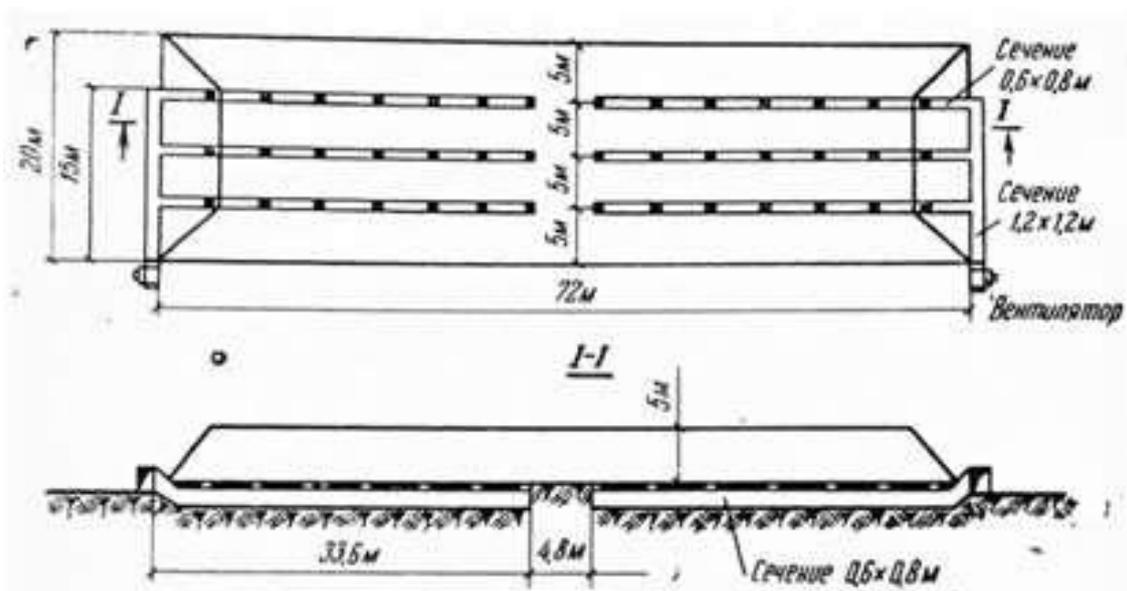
Поздовжня схема вентиляції розташування вентиляційних гілок
